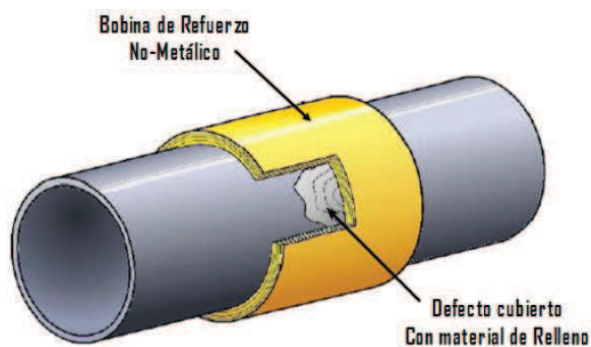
Bobina de refuerzo no metálica ^[5]
